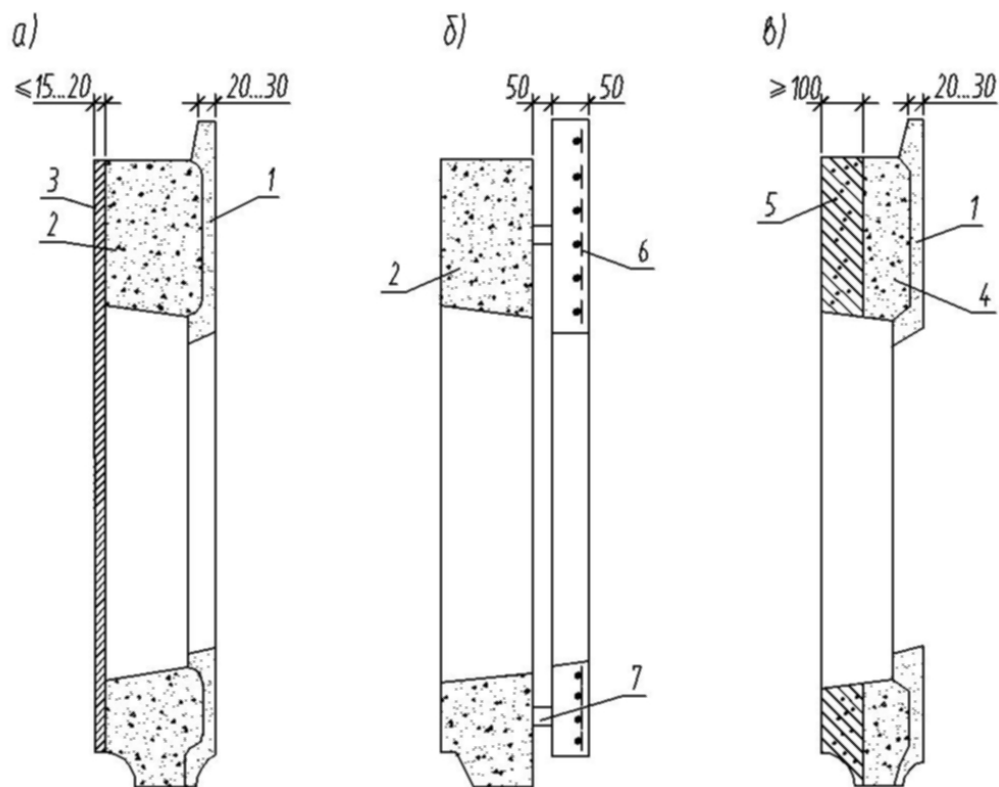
Конструкции однослойной и двухслойной бетонных панелей наружных стен:
